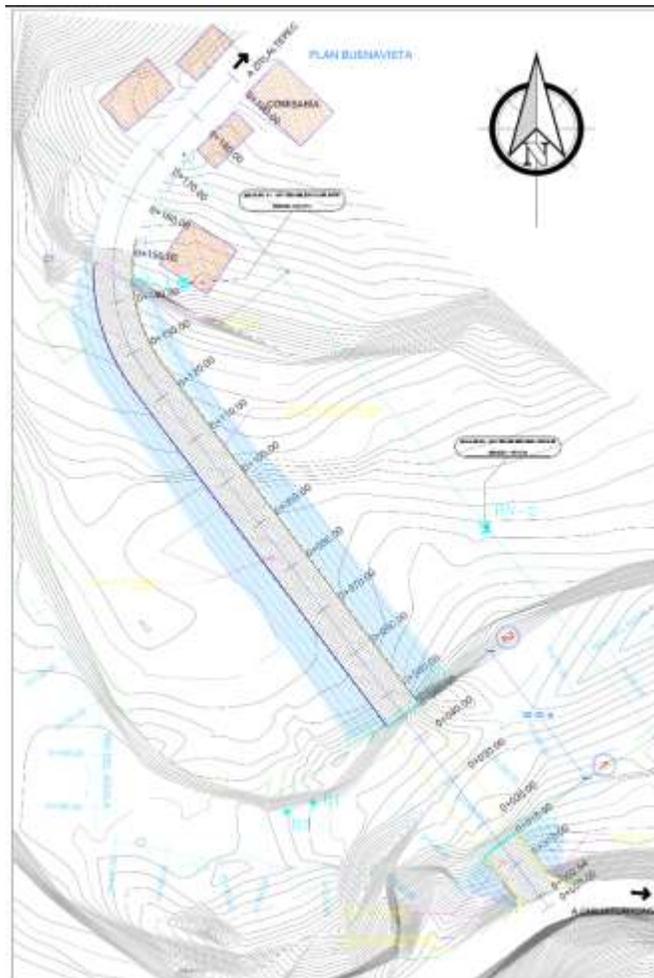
Vista Plano del Puente Vehicular Plan Buenavista
